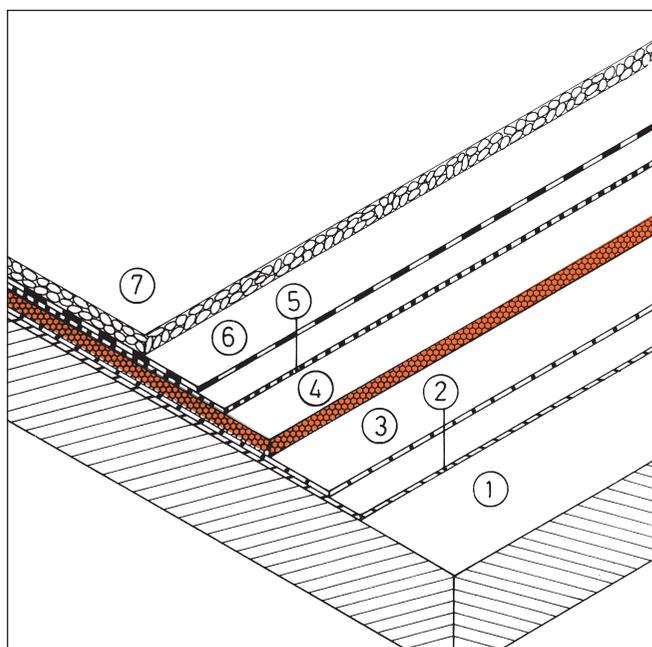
Isolamento sotto impermeabilizzazione di tetto piano.
